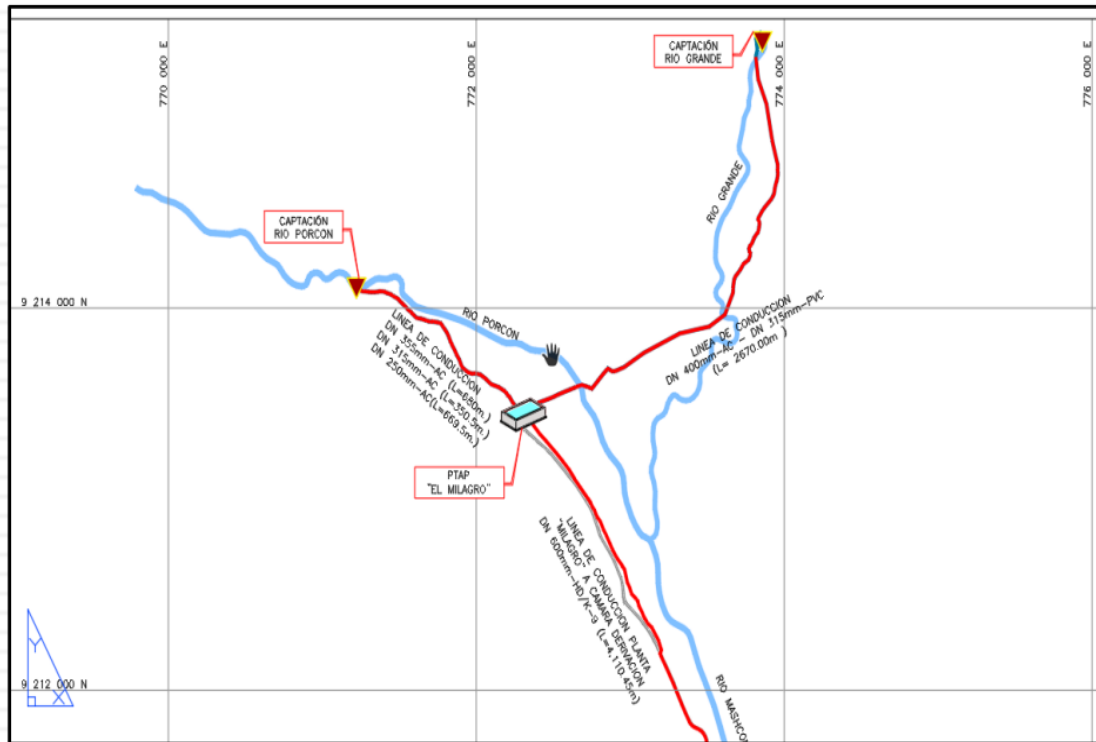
VISTA PLANTA EL MILAGRO:
